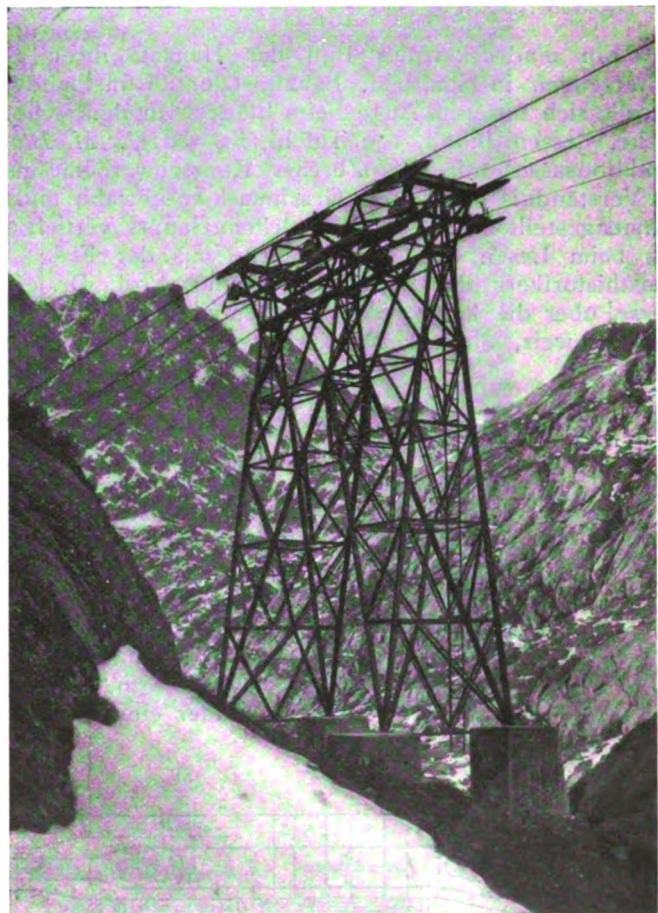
Eiserner Pfeiler mit drei Auflagern der Luftseilbahn G-F von der Kiesaufbereitungs- nach der Betonzubereitungs-Anlage.
